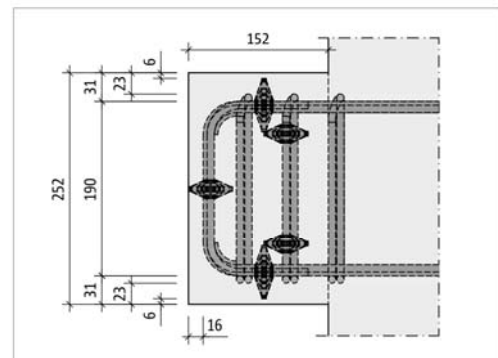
Schöck Tronsole® Typ Z: Grundriss einer Auflagerkonsole mit eingebautem Tragelement
